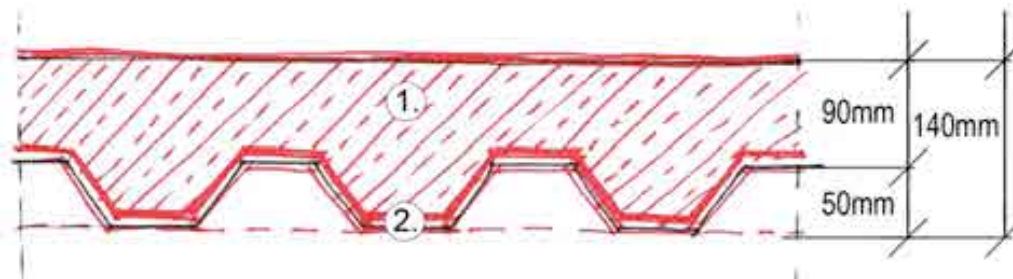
Probenabschnitt Decke Trapezblech 14cm
